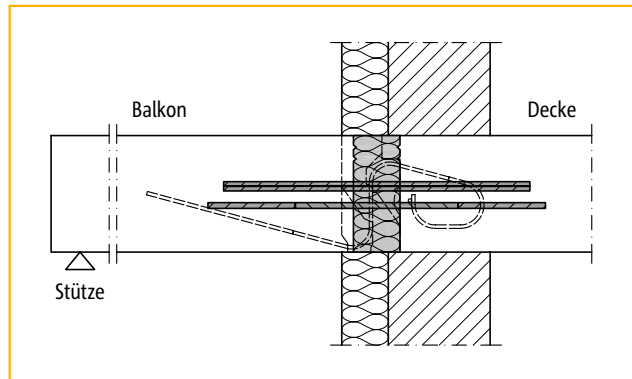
Mauerwerk mit Außendämmung bei deckengleichem Balkon + Typ V + Typ HP-C
